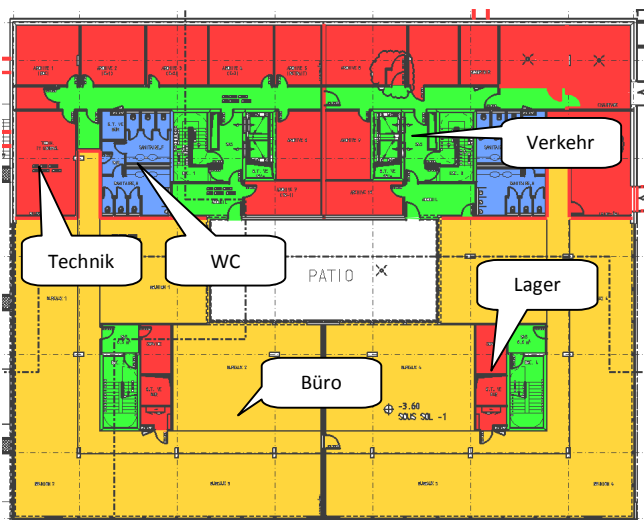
Grundriss Regelgeschoss mit Zonierung, Geb.3
